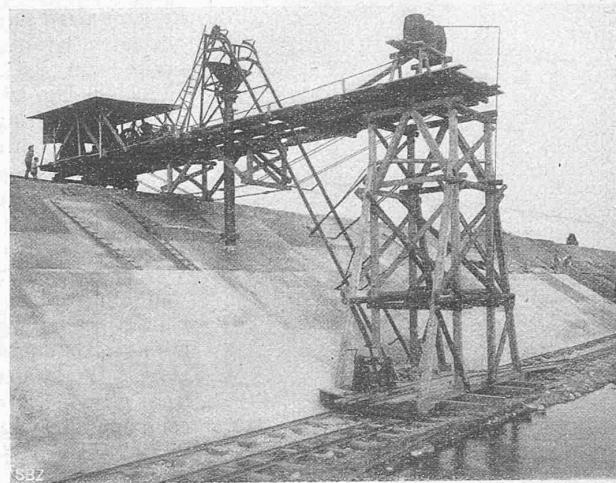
Betonaufzug für die Betonierung der Böschungen.
